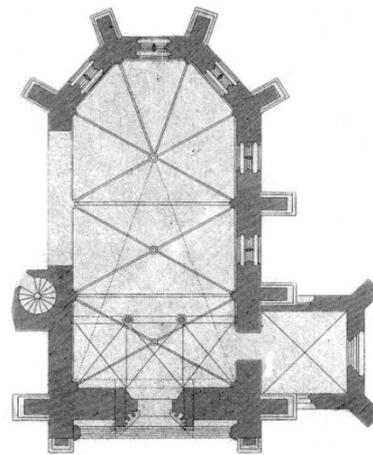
Košice, Michaelskapelle, Grundriss, Ende 14. Jh.
